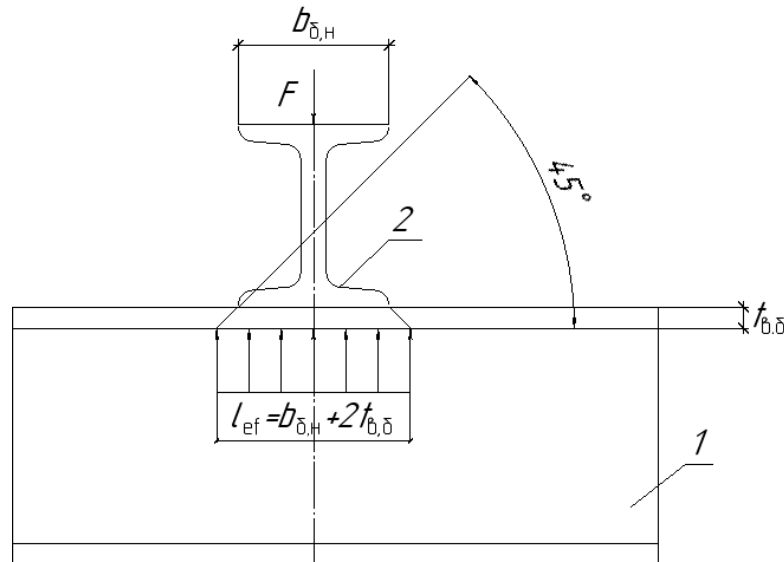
Распределение местных напряжений: 1 - вспомогательная балка; 2 - балка настила
